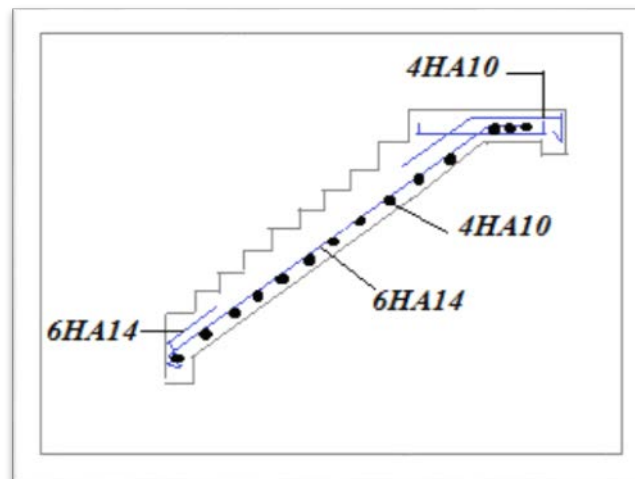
schéma de ferrailage d'escalier RDC type 01du
